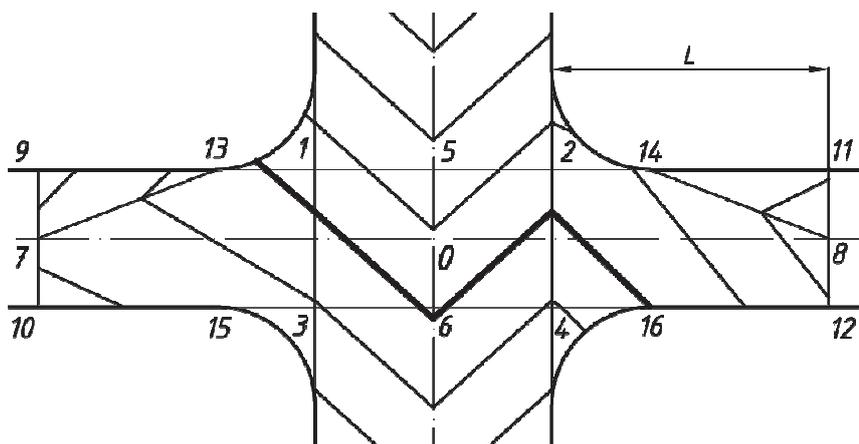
Схема вертикальной планировки перекрестка на косогоре
